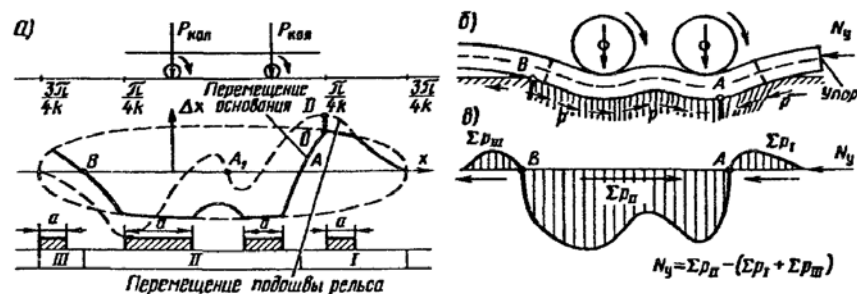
Схема формирования продольных сил угона пути при проходе двухосной тележки вагона (жесткий упор надежно закреплен впереди рельса, препятствуя продольному “проползанию” его): а — эпюра перемещения подошвы рельса и основания; б — схема упругого отклонения сечения основания в I, II и III зонах с указанием отклонения продольных сил p ; в — эпюра продольных сил в основании рельса, результирующая которых реализуется как давление на жесткий упор N_y ; а — участки проскальзывания
